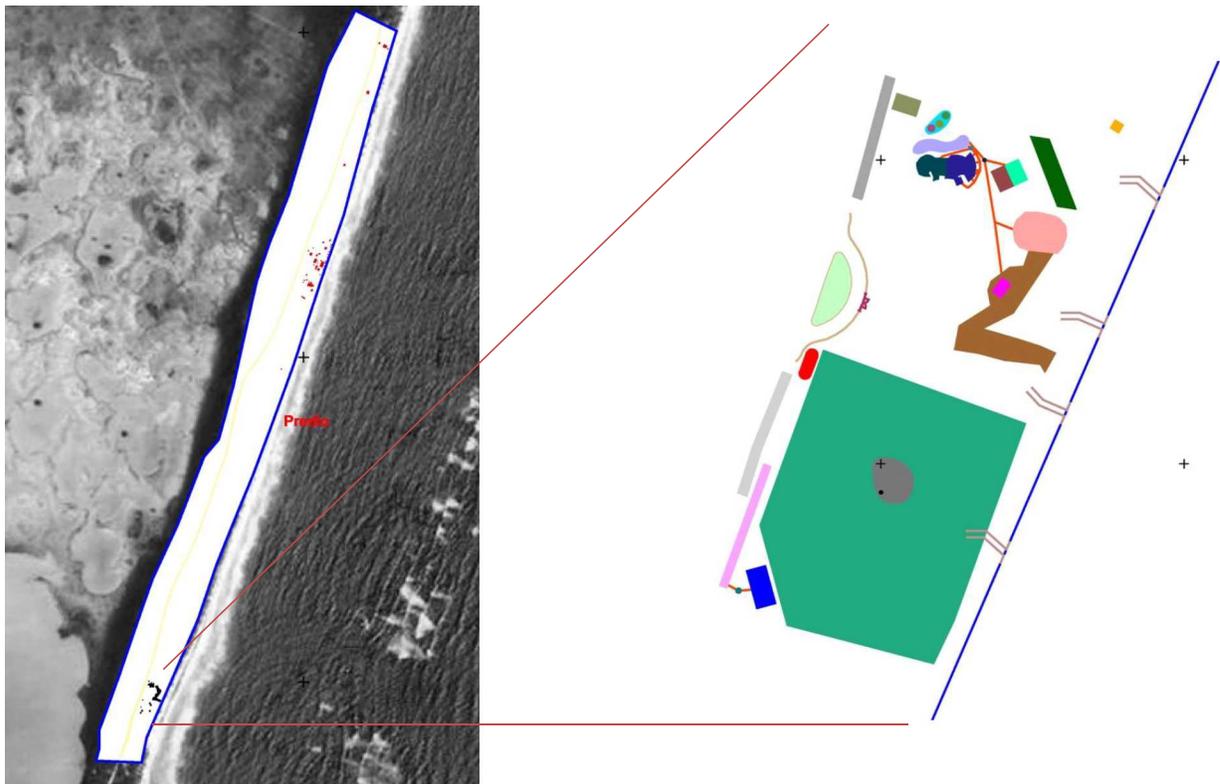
Ubicación de las obras contempladas en el proyecto Campamento Ka'an.
